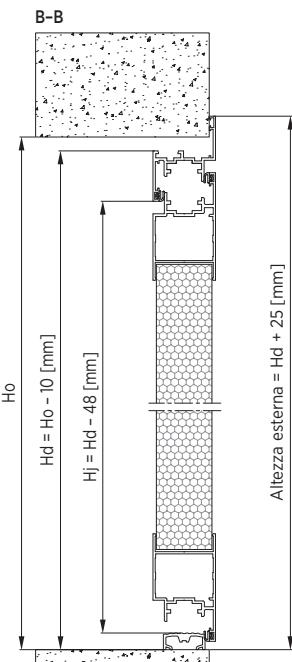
Dipendenze dimensionali – sezione verticale – porta a un'anta - sistema AW45 con telaio angolare.
